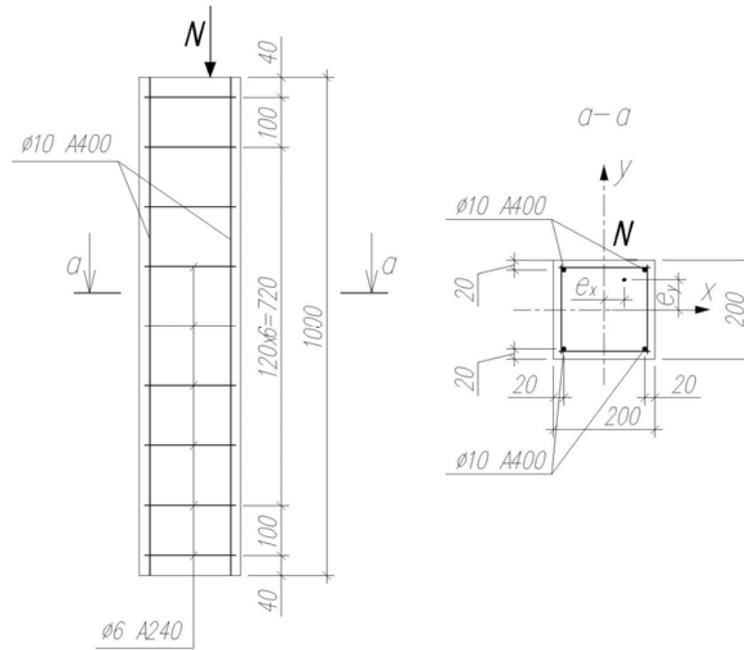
Схема армирования фиброжелезобетонного элемента и приложения нагрузки
